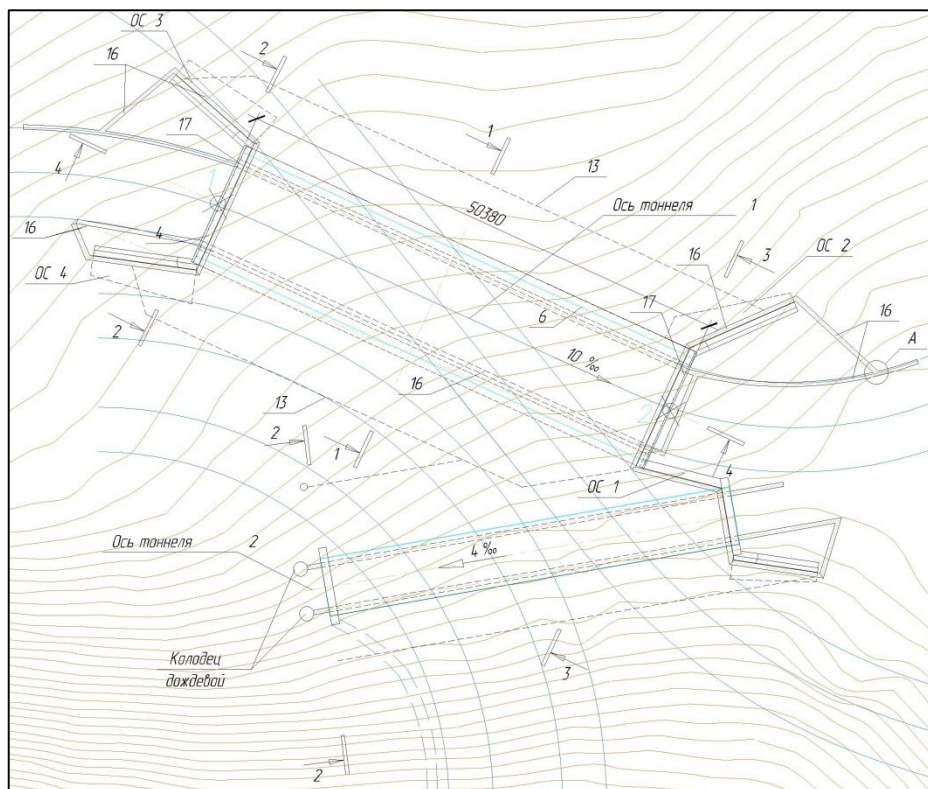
Фрагмент генерального плана тоннельных переходов
